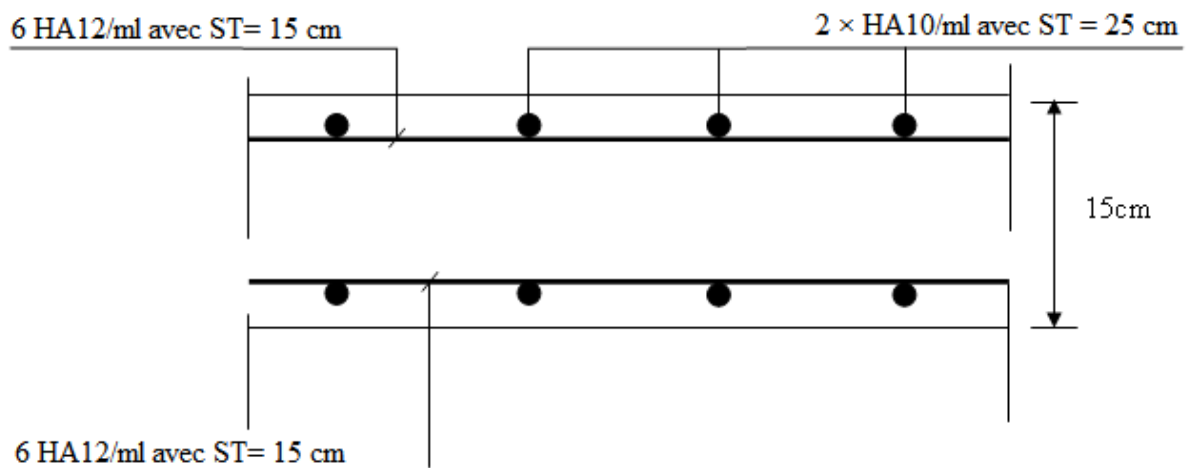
Ferrailage de la dalle dans le sens x-x.
